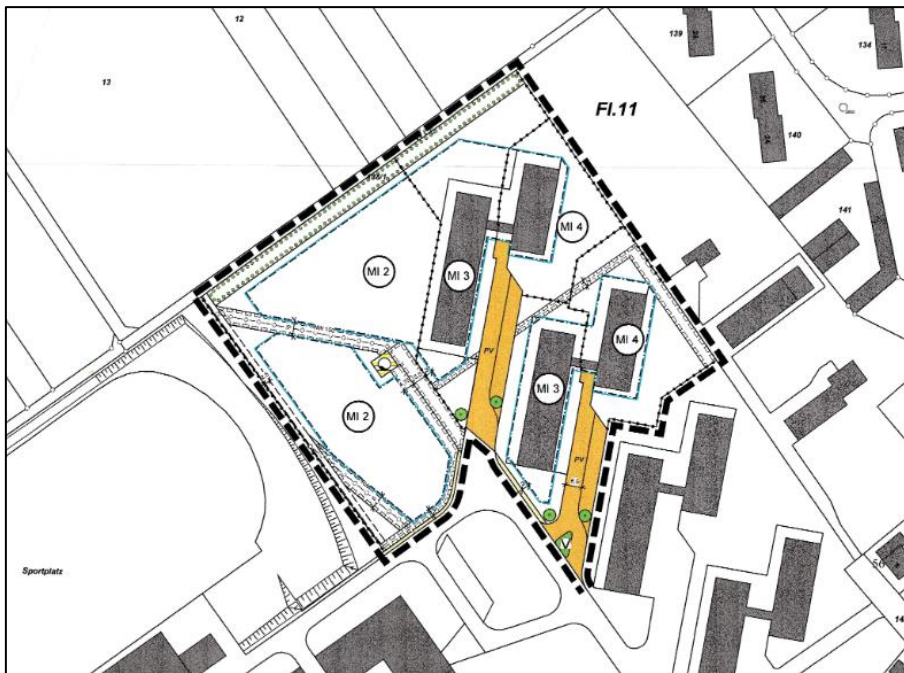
Bebauungsplan Wohn- und Gewerbepark „Goldschmiedswiese“ – 1. Änderung, Rechtskraft 21.06.2004
